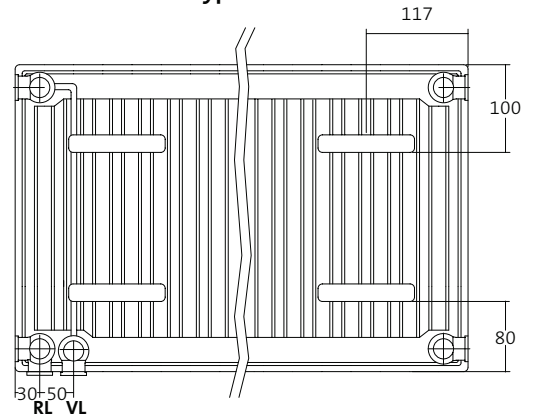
Laschenmaße für Plan Ventil Compact Typ 11 und Ramo Ventil Compact Typ 11 mit Befestigungslaschen (Rückansicht)
